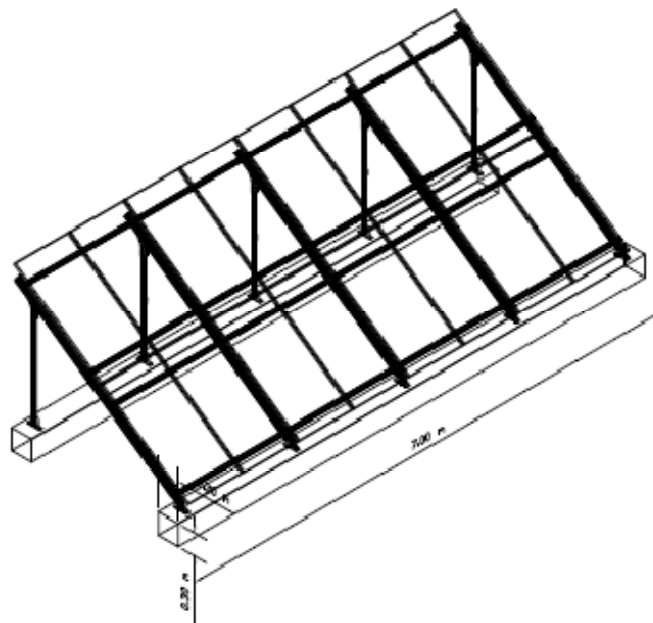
Cimentación estructura soporte sub-generador 1
